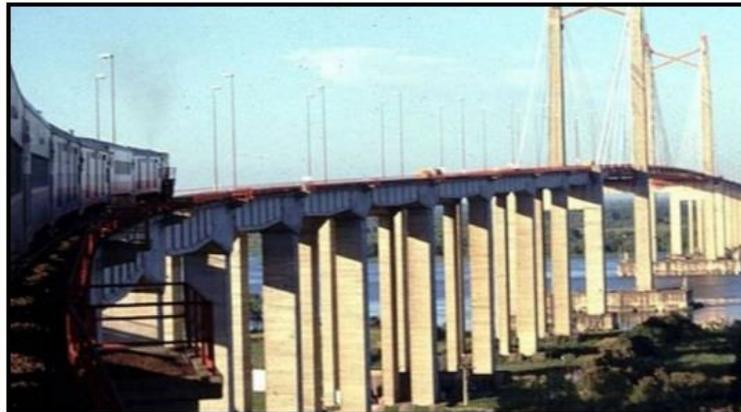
Puente Zarate - Brazo Largo. Fuente: www.google.com.ar.
